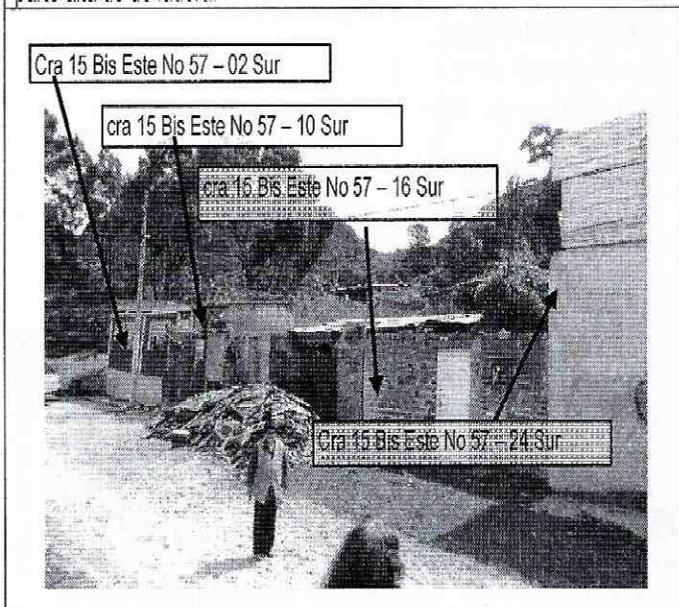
y 5. Fachadas de acceso de los predios evaluados Carrera 15 Bis.
